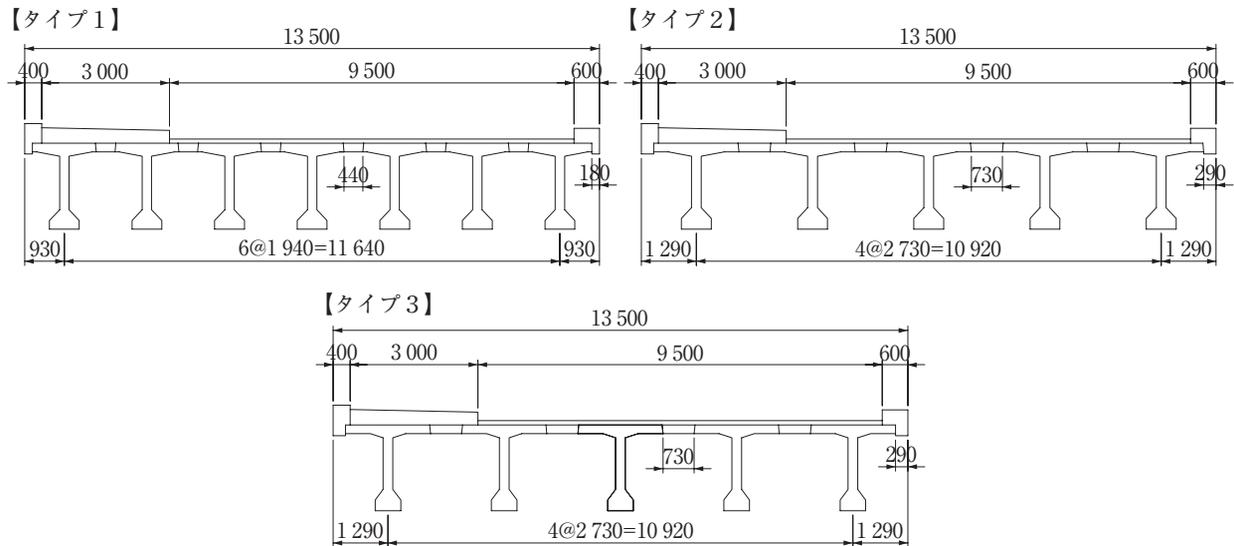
ポストテンション方式バルブTげた橋 断面図
